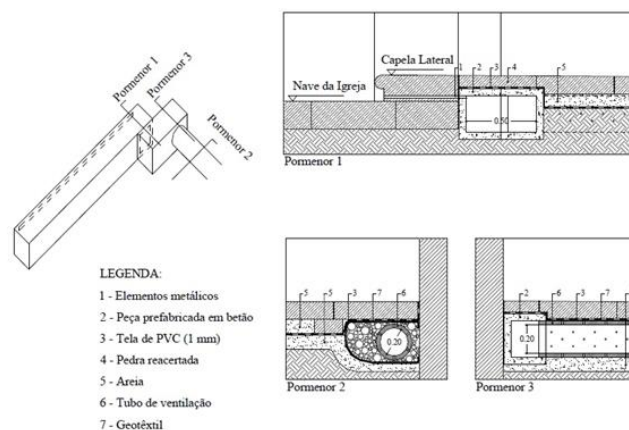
Pormenores do sistema ventilação da base das paredes interiores [3]
